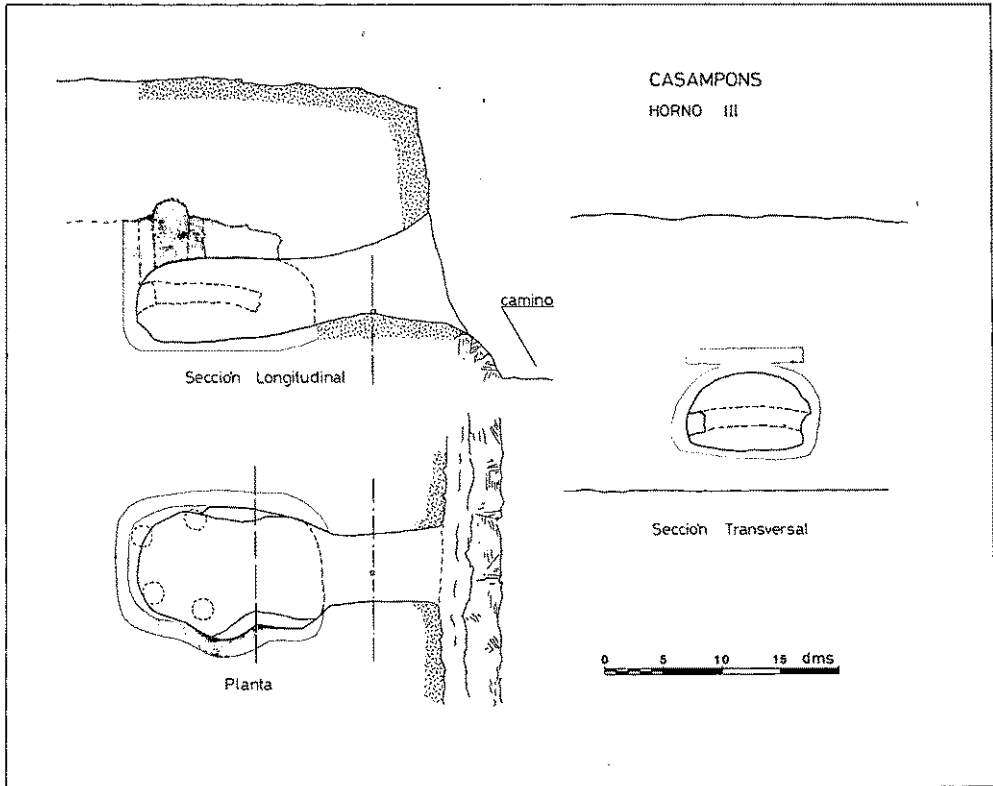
Horno III de Casampons. Planta, sección longitudinal y transversal de los restos de aquella construcción, según el Diario de Excavación.
